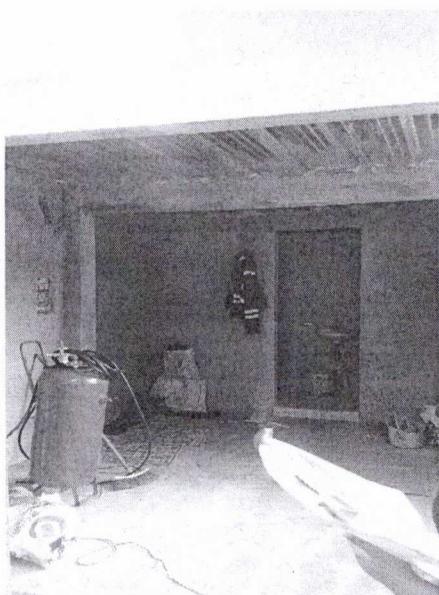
vista desde el segundo piso parte posterior. Se observa a obrero trabajando en la cubierta.
